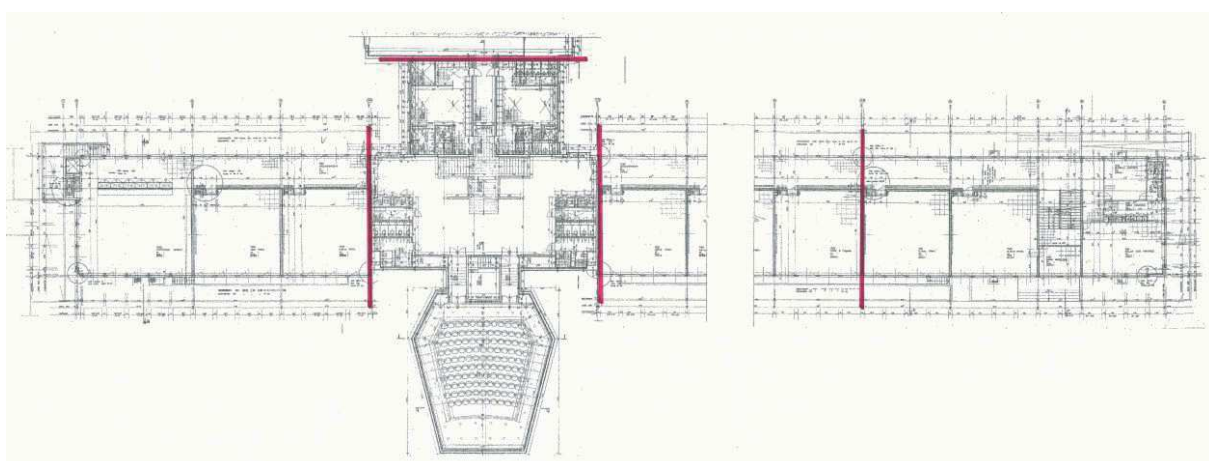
De gauche à droite, aile Ouest, Corps central et Est - PLAN 1ER ÉTAGE
